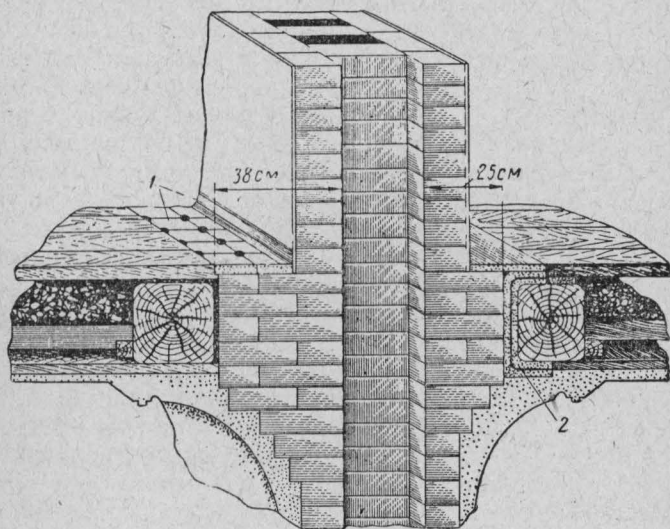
Разделка от дымохода до деревянных конструкций перекрытия:
